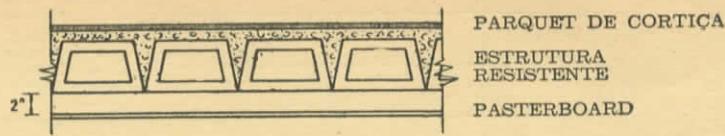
Isolamento sonoro de um pavimento aligeirado (BUILDING RESEARCH STATION).
